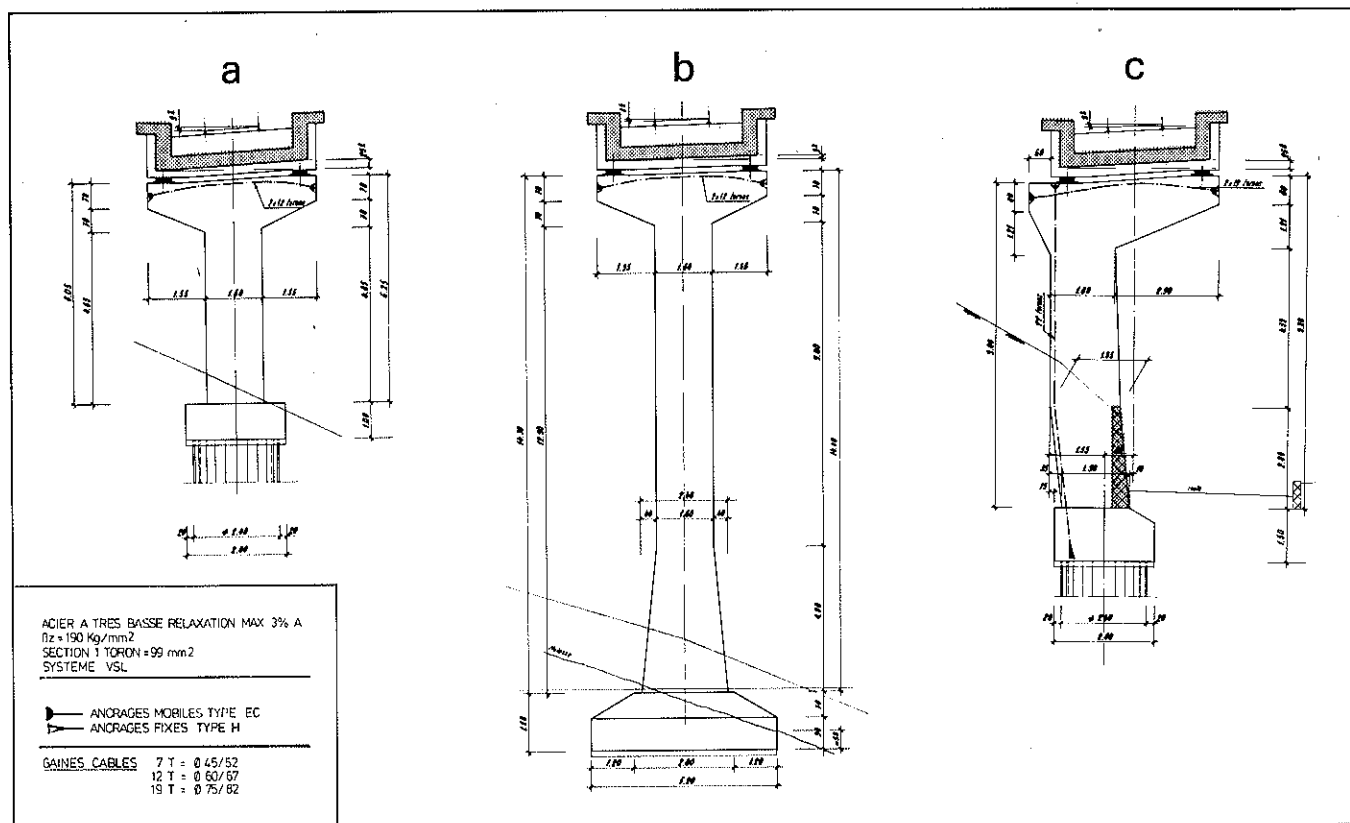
Pont de l'EPSIC; a: pile courante fondée sur puits; b: pile N° 5 fondée sur semelle; c: pile N° 2 à forte asymétrie.
